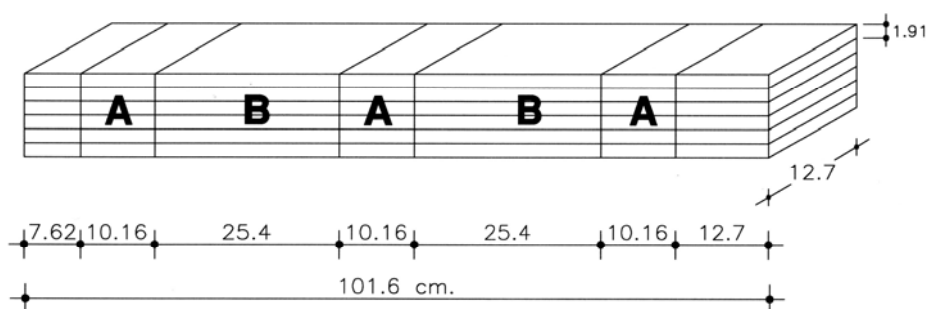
Ubicación en la viga de las secciones A y B
